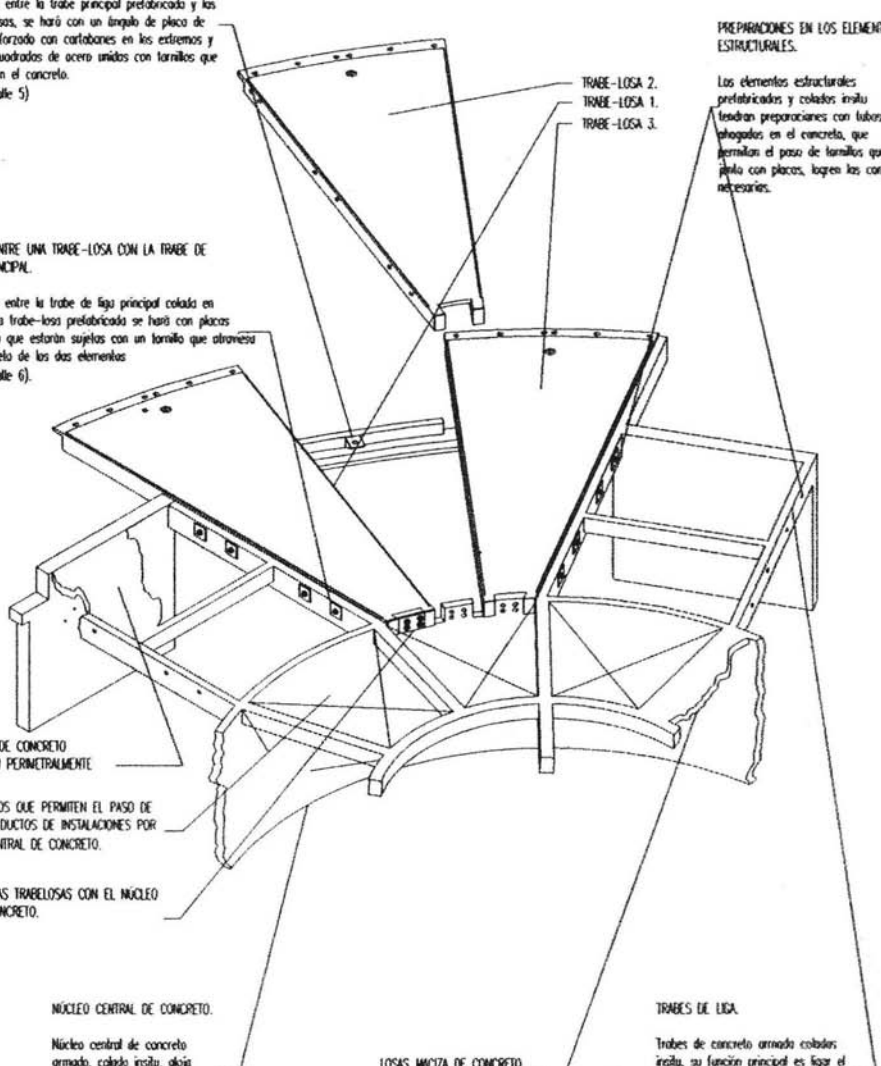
Ensamblaje del sistema constructivo 1.
